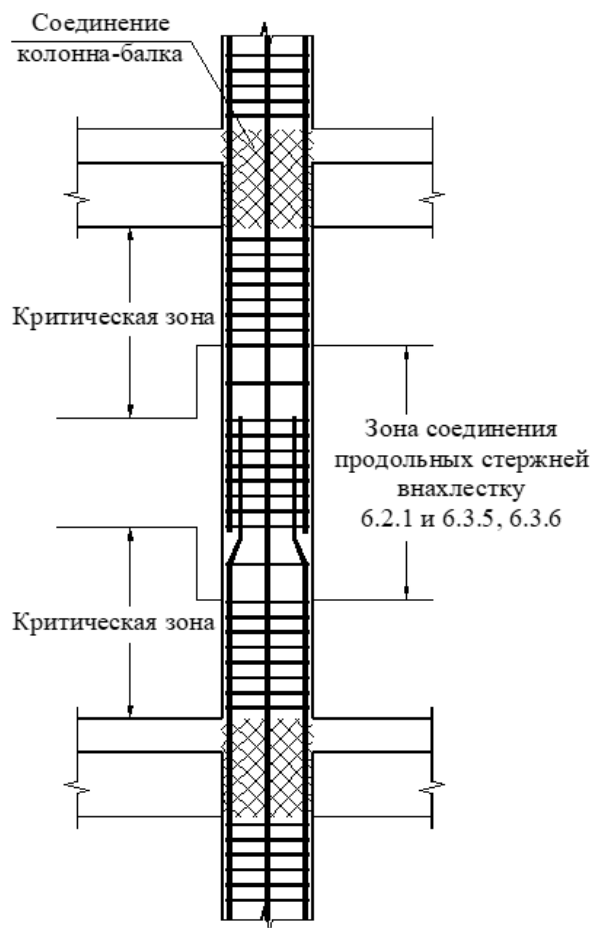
Пример армирования зоны стыковки стержней внахлестку в колонне
